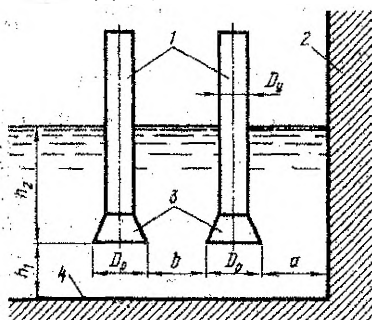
Схема расположения всасывающих труб в береговом колодце
